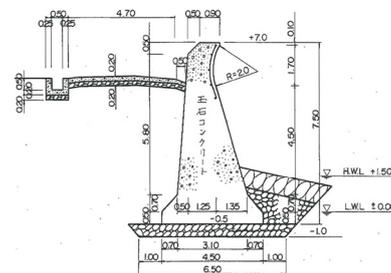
調査対象施設(護岸)の標準断面図(小田原漁港)
